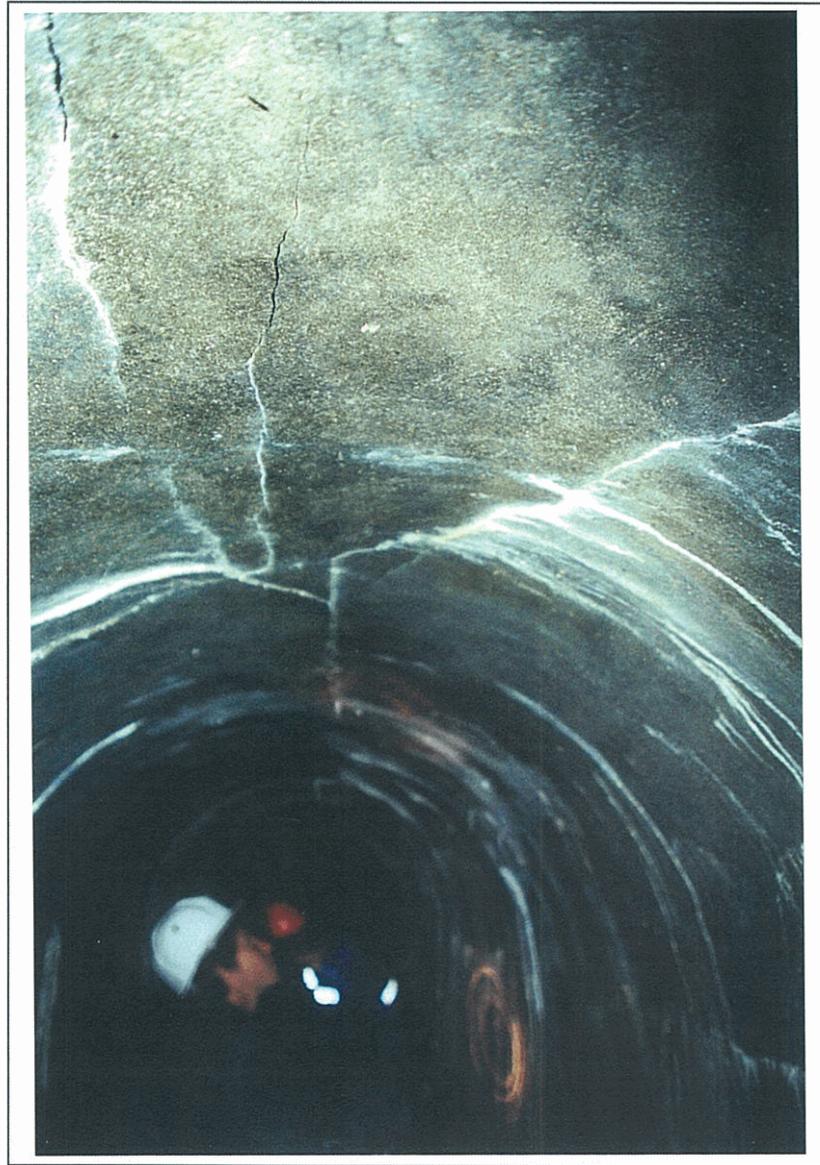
fissuration du revêtement de la galerie avec progression récente (fissures non blanchies).
